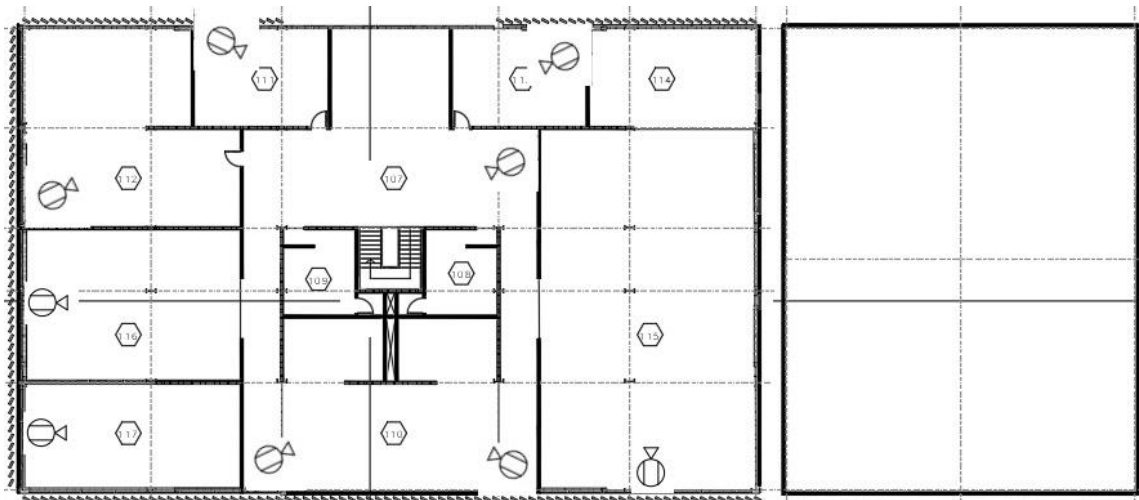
Sistema CCTV Planta 2 edificio administrativo
